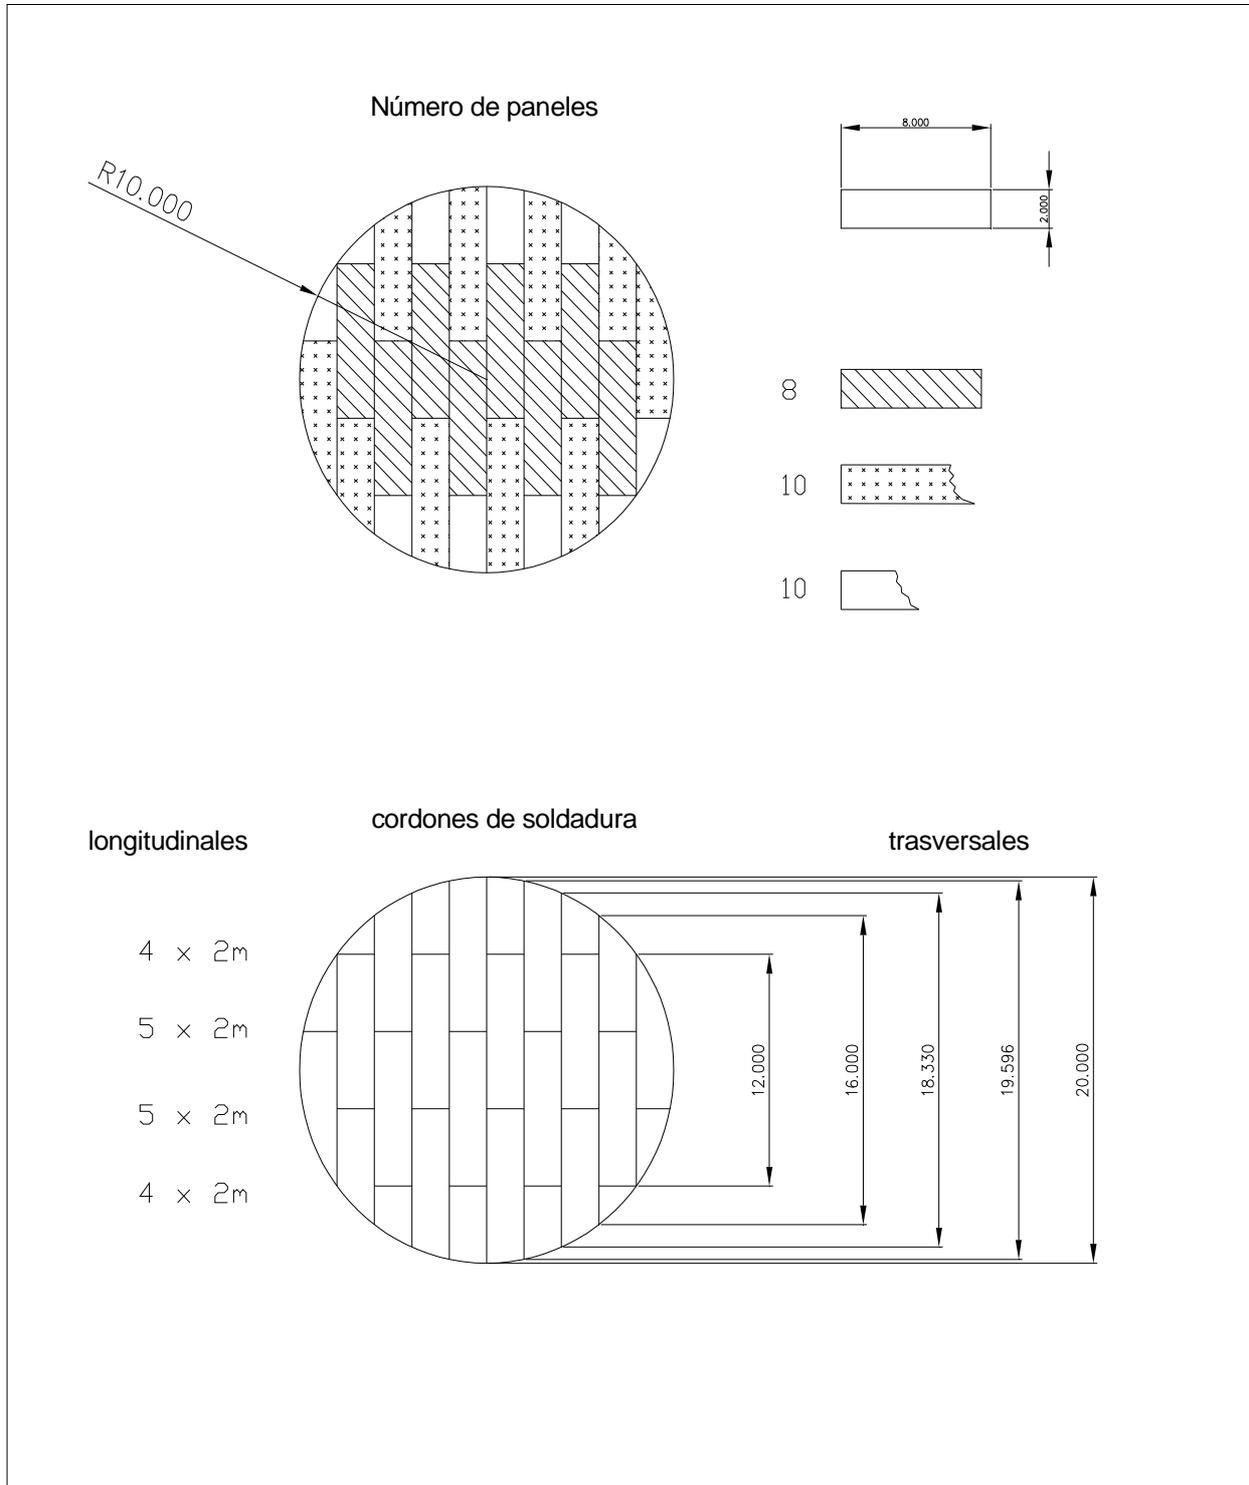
Soldaduras y fondo del tanque N°3 .
